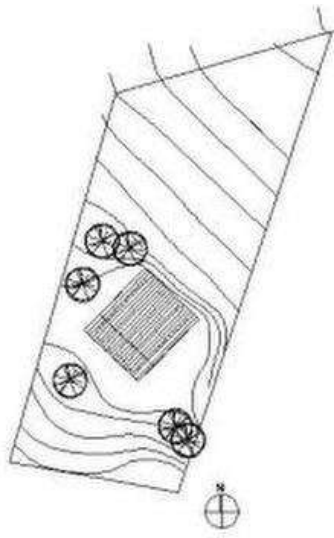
Planos en planta de cabaña tropical, Brasil.
